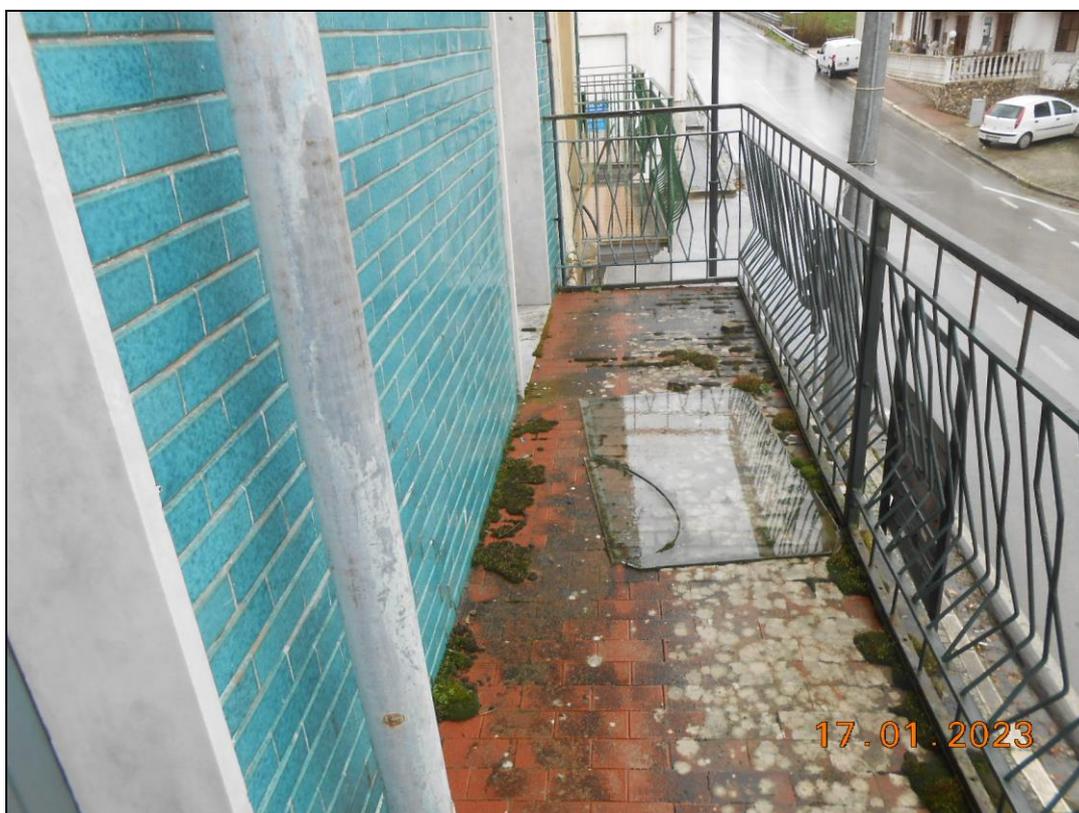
Vista dei balconi a piano primo. Si nota lo stato di degrado.
